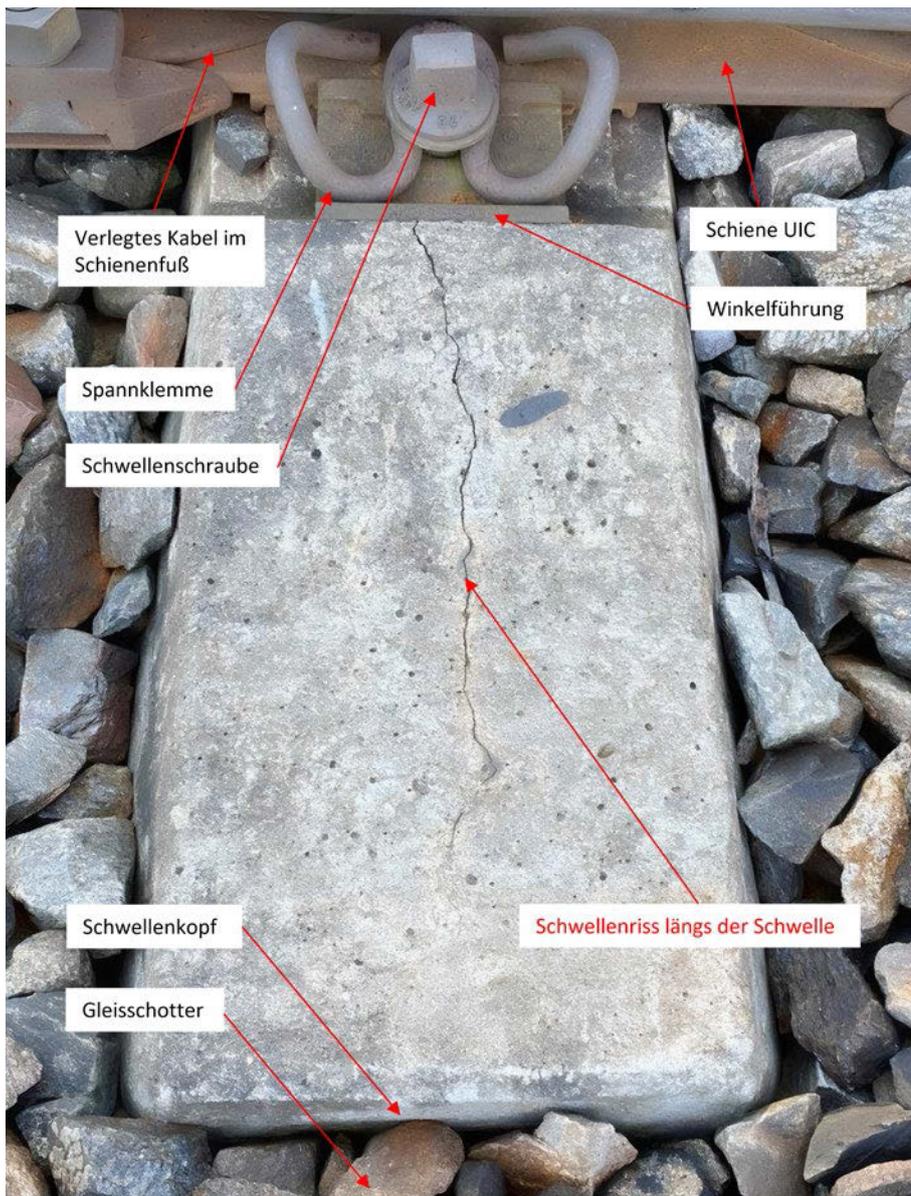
Draufsicht auf einen Spannbetonschwellenkopf mit Schwellenriss
